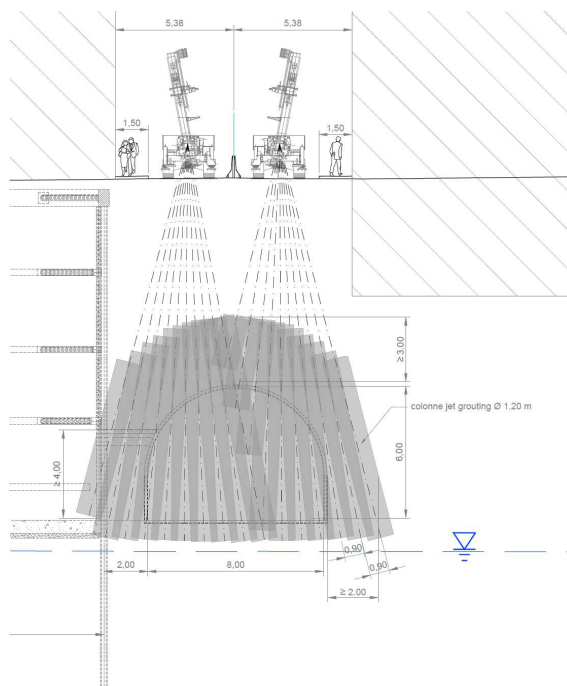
Trattamento jet grouting per il cunicolo PS-GT5: sezione di tampone.
